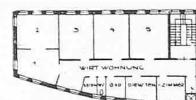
(unten). Erdgeschoss-Grundriss und Platzbildung 1:800.
